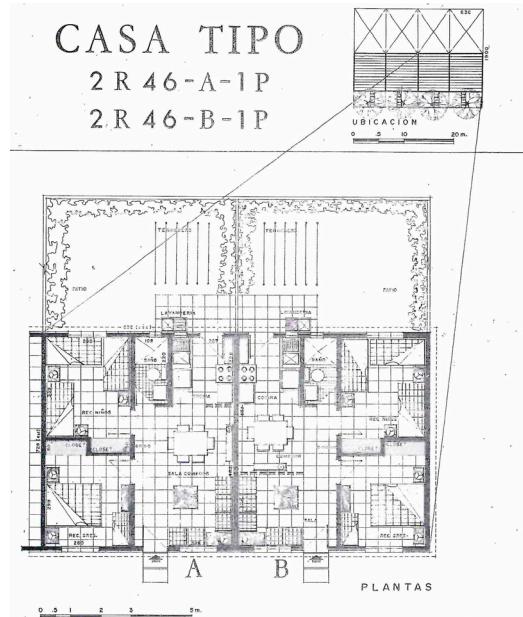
Planta arquitectónica de vivienda popular. Dirección de Planificación del Estado de Nuevo León/Referencia: Plan Operativo de vivienda popular (1968).
